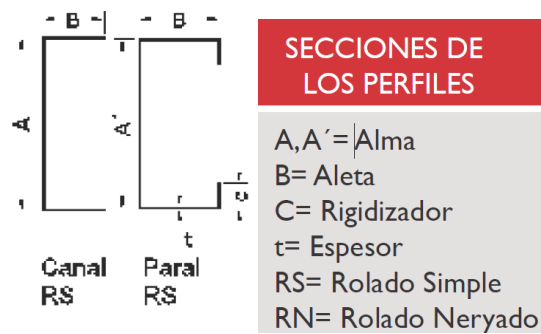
Sección transversal de los perfiles canal y paral de la estructura
